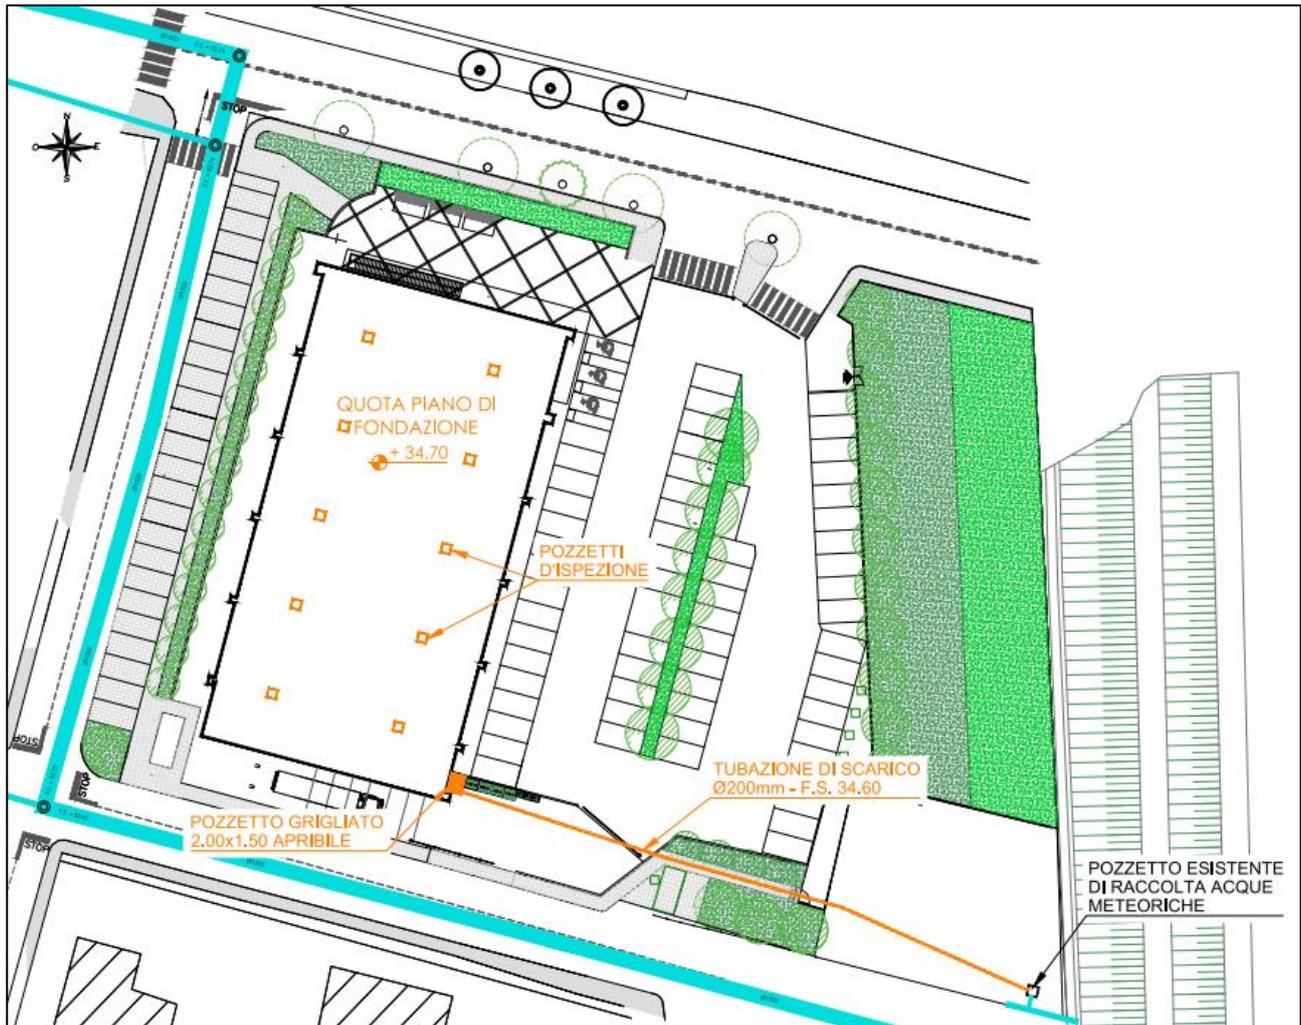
ESTRATTO PLANIMETRICO DELLE OPERE DI CAPTAZIONE
